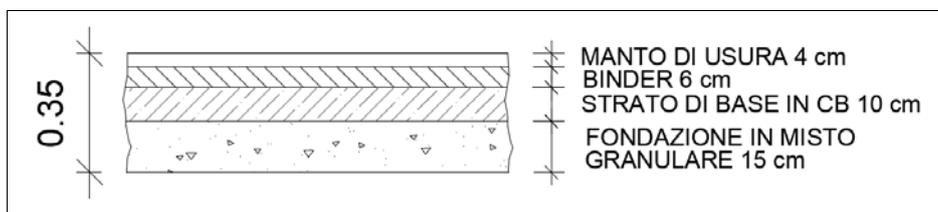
PAVIMENTAZIONE PREVISTA PER LA VIABILITÀ SECONDARIA
